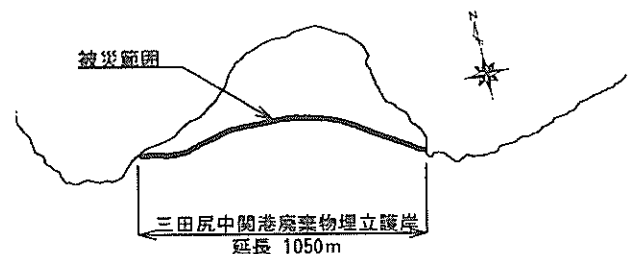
三田尻中関港廃棄物埋立護岸 全体平面図
